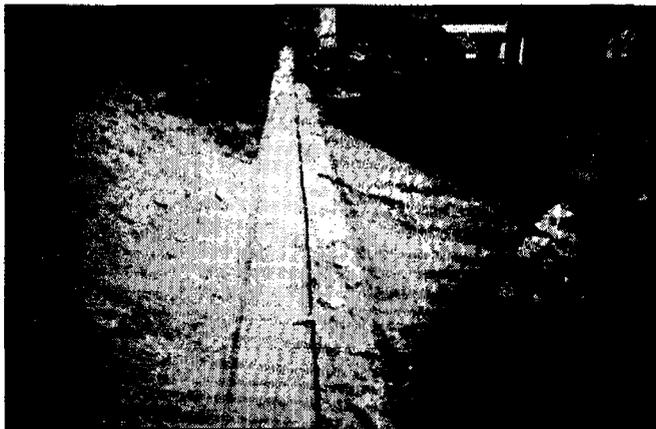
Intersección de las nuevas cimentaciones y el muro quebrado.
